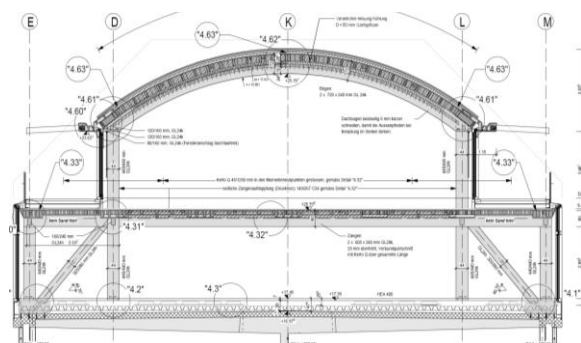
Croquis coupe SQ8, uniquement niveau 4/5
